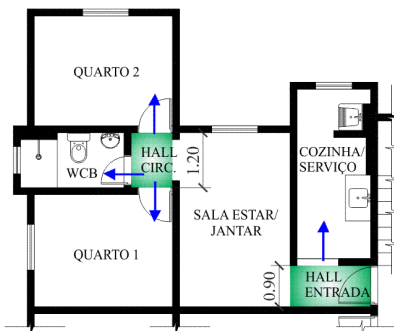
Planta Baixa Pav. Tipo: Hall de Circulação do Residencial Int. Luiz dos Anjos (sem escala)
